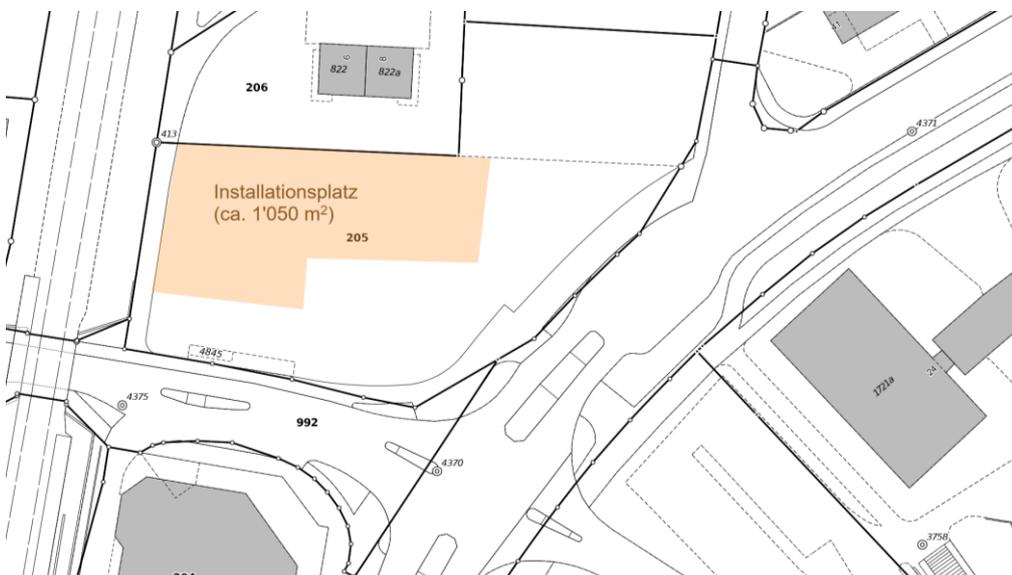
Ausschnitt Grundbuch mit Installationsplatz
